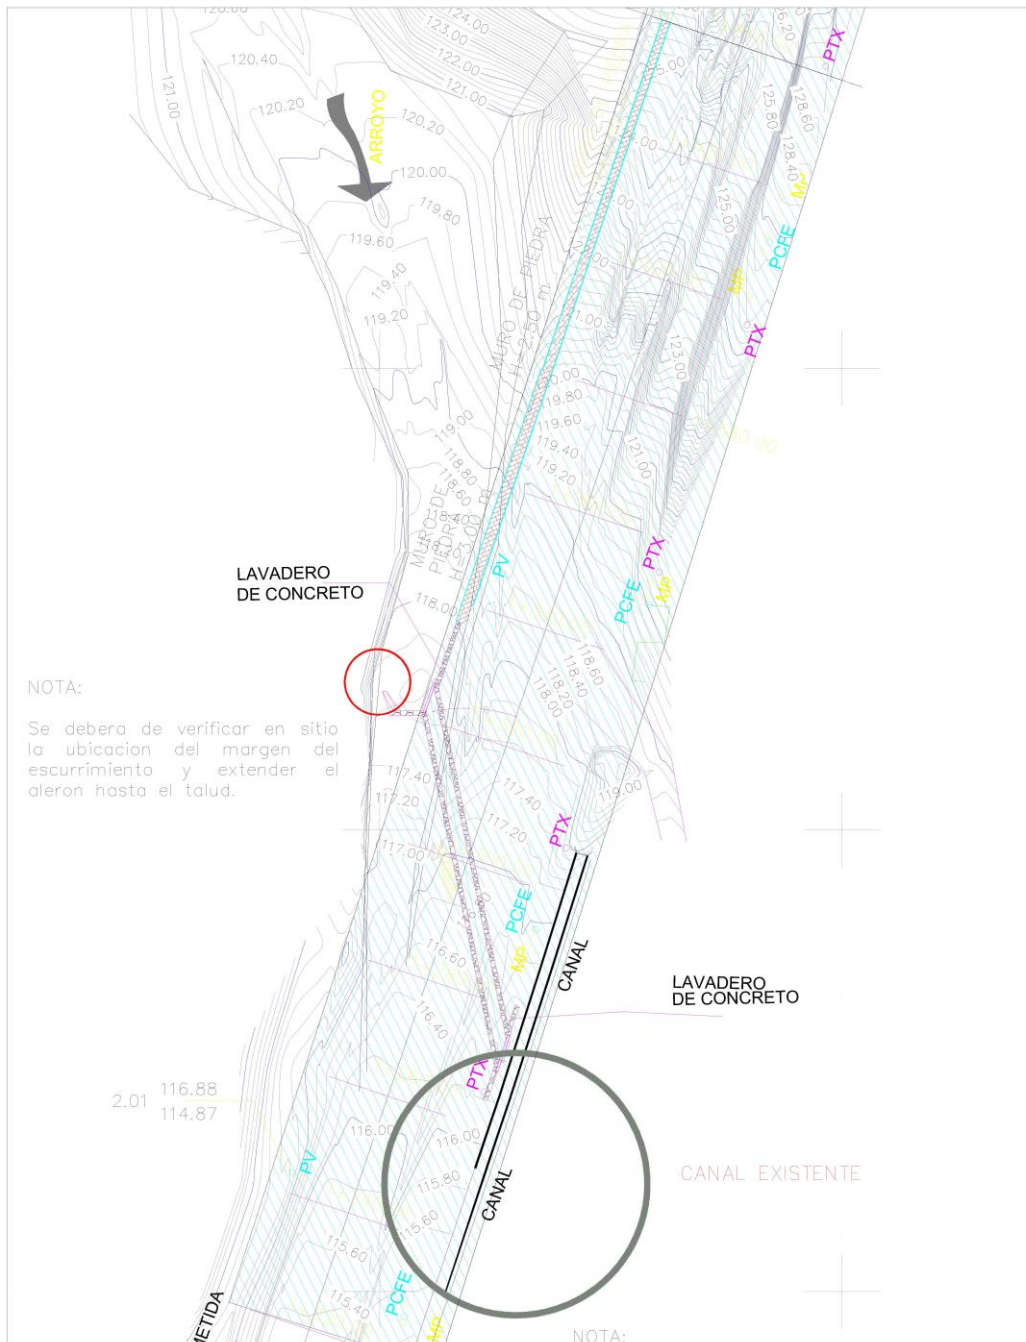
Tramo 3 del proyecto, muro de piedra y canal.
